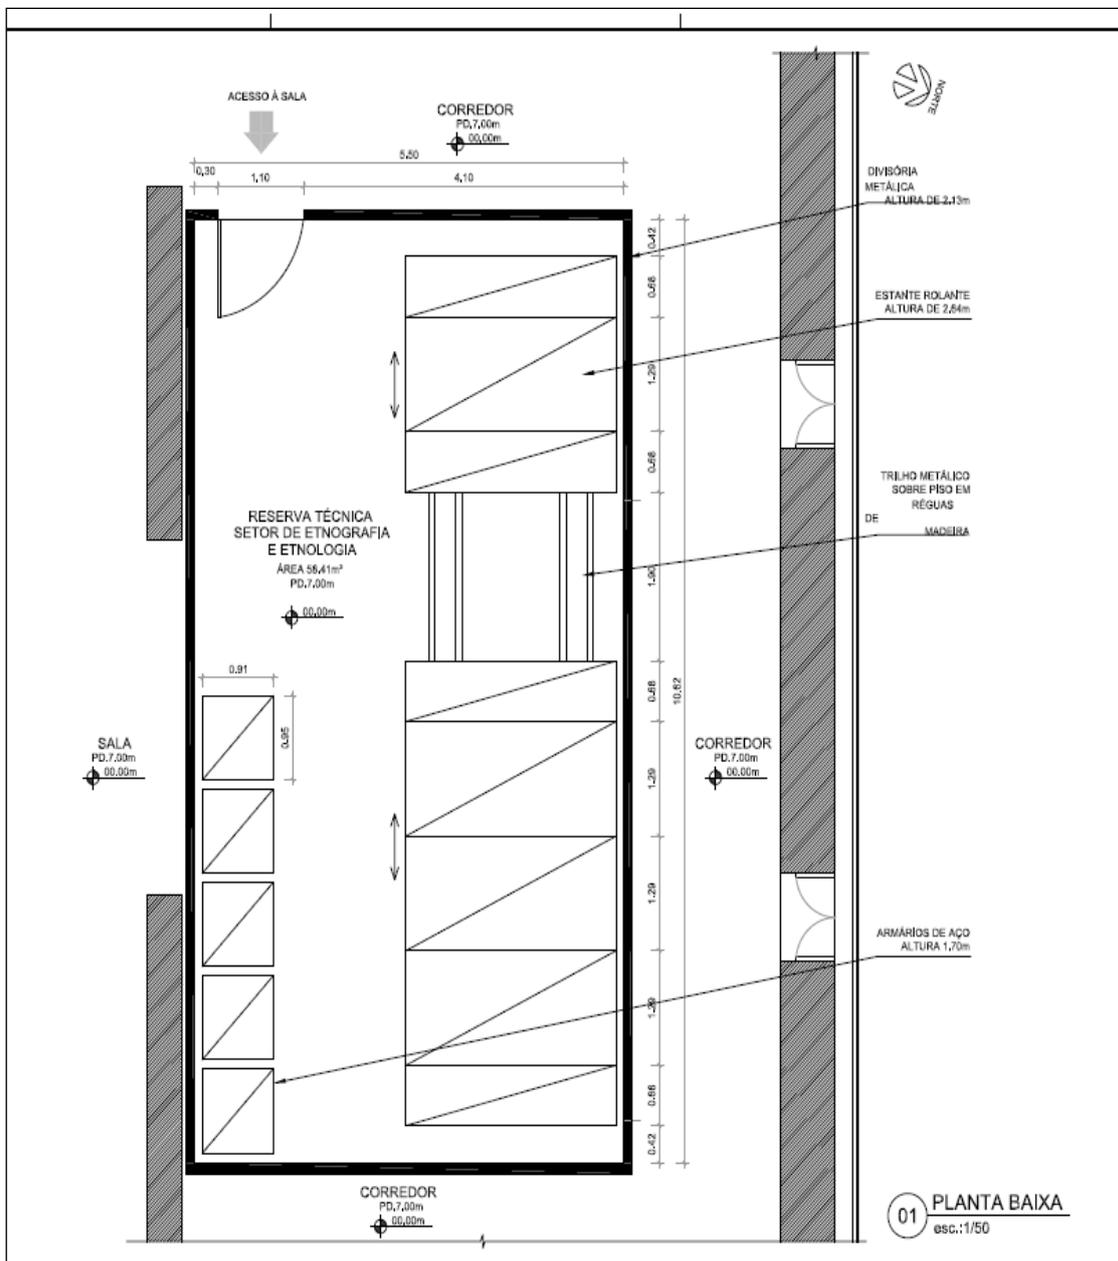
Planta baixa da Reserva Técnica do setor de Etnografia e Etnologia (Planta em tamanho A3 no Anexo 1).
